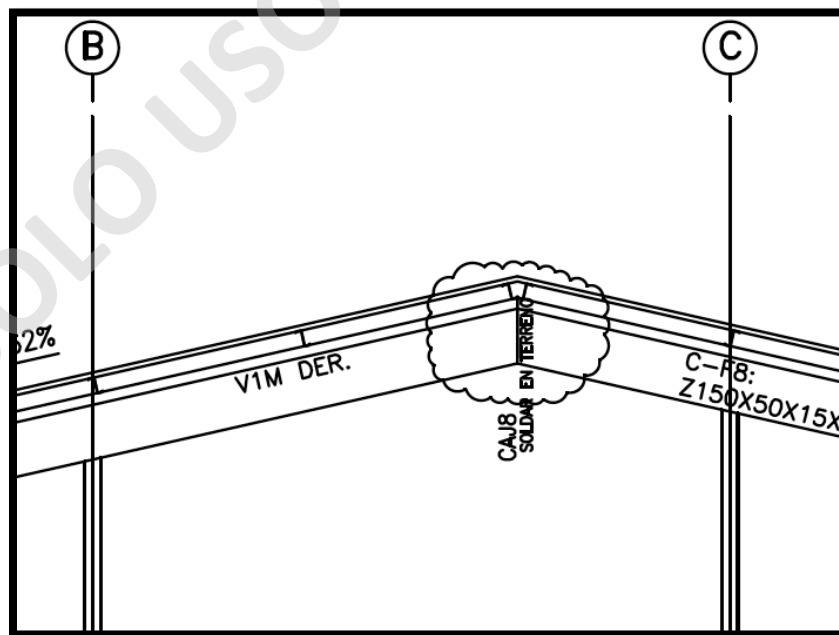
Detalle de Soldado Plano de ODR Ingeniería y Montajes
